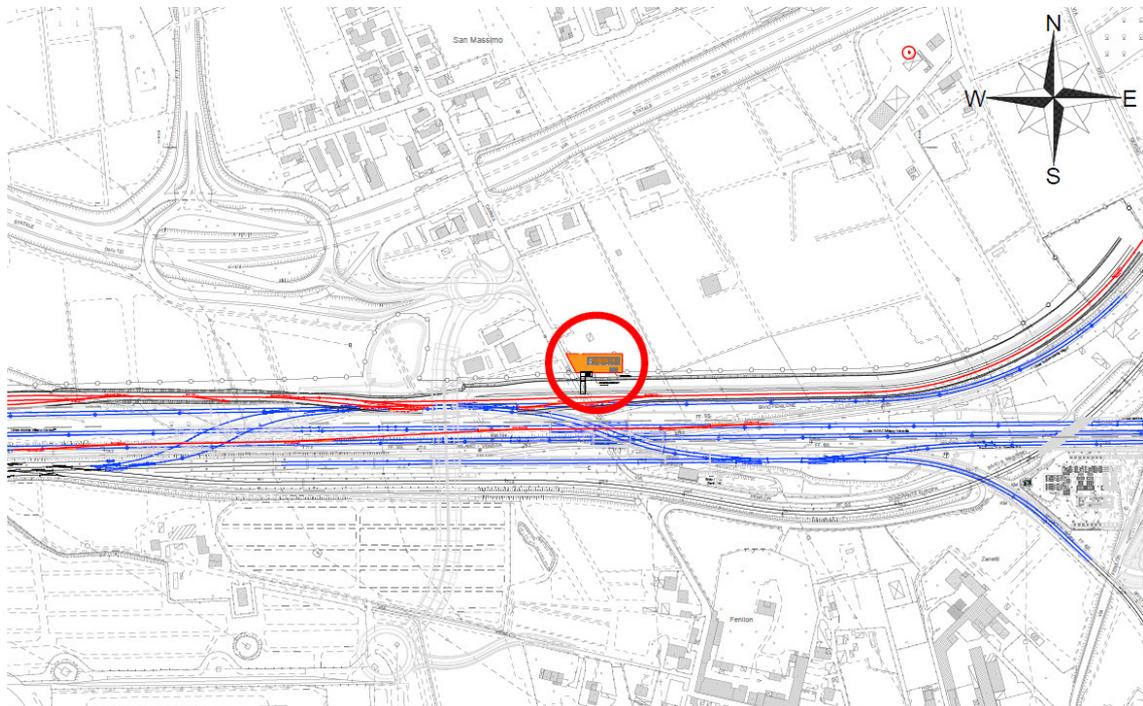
FA03 – Stralcio planimetrico del fabbricato
